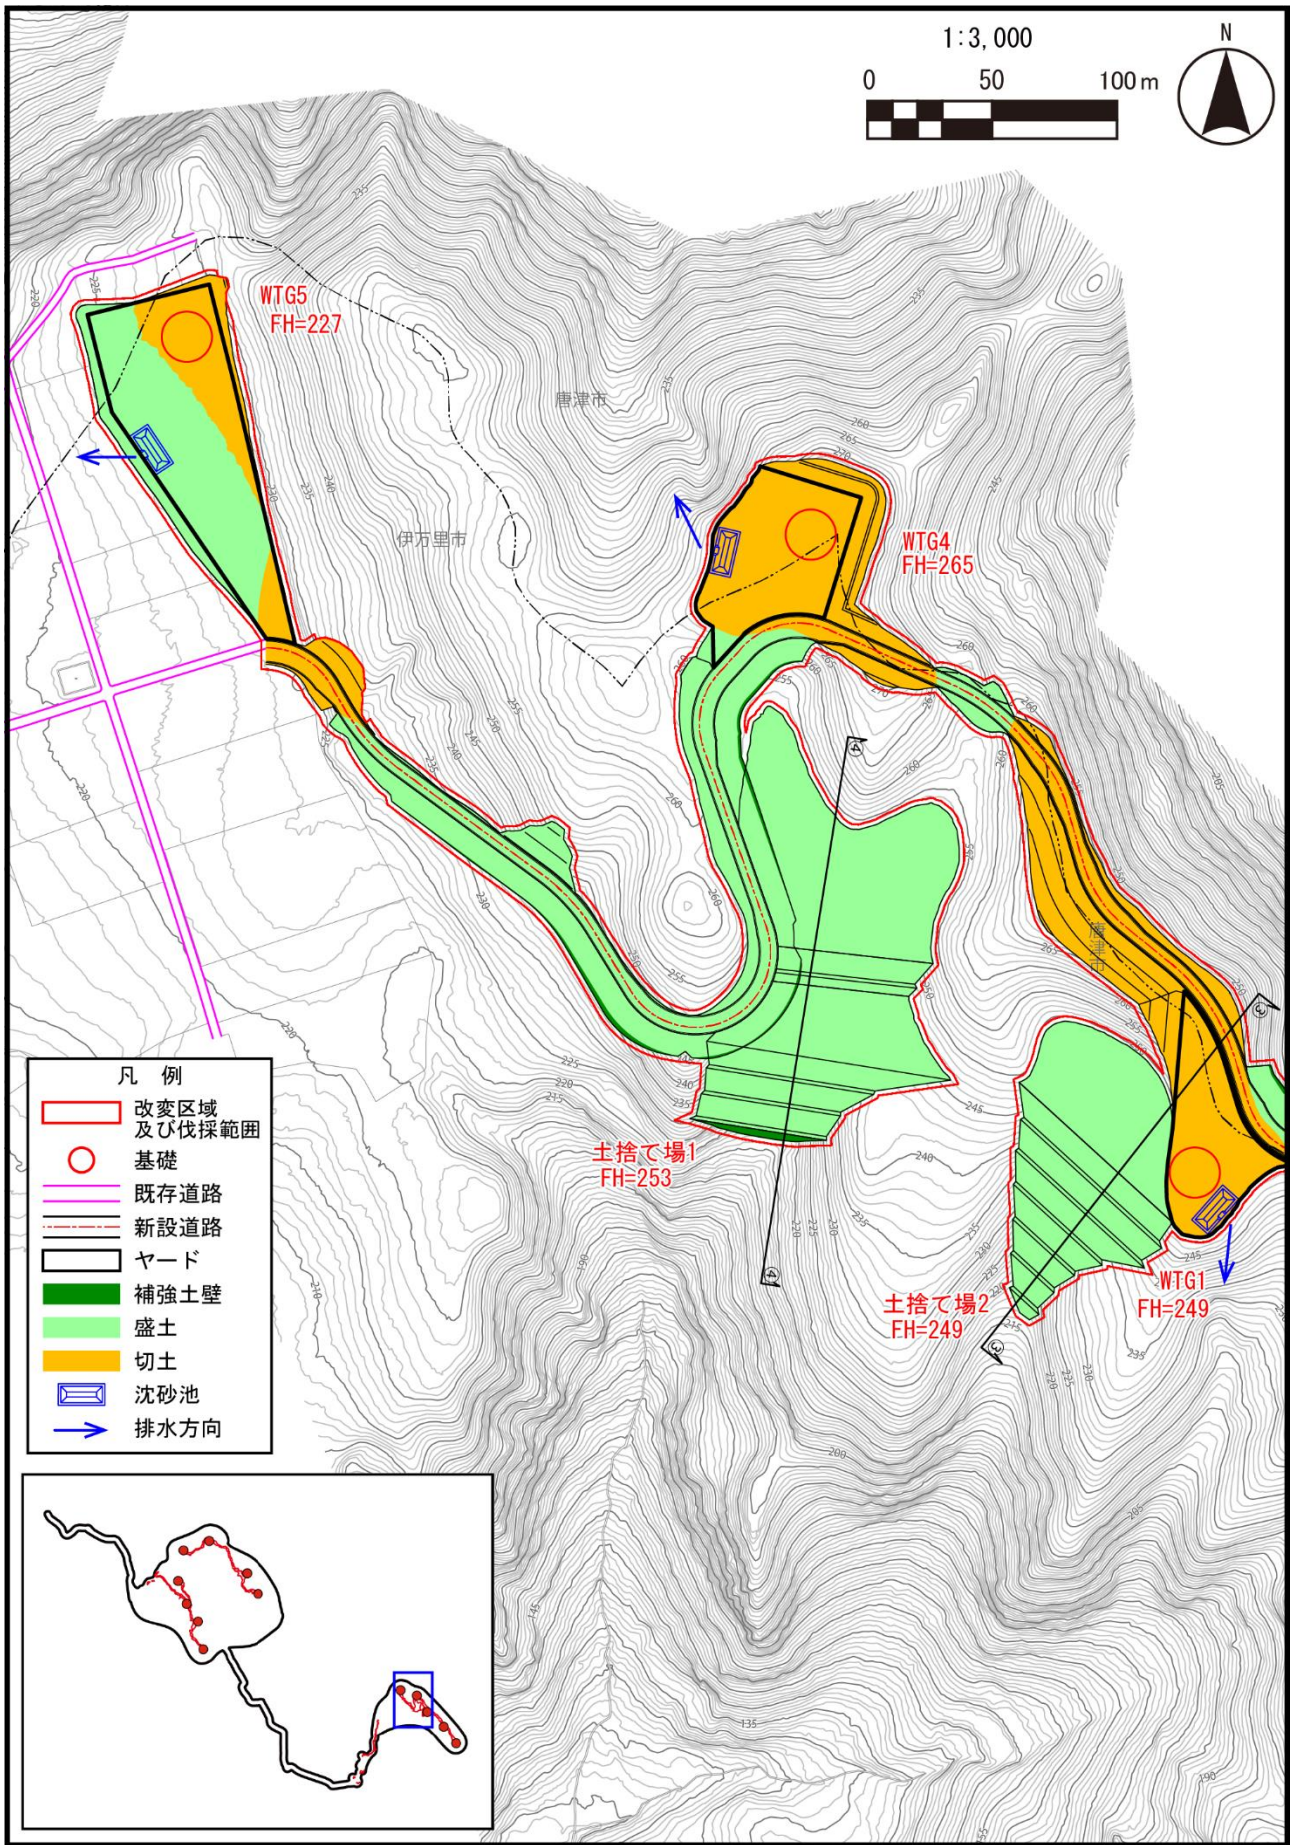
(2) 土捨て場の断面図 (断面の場所)
